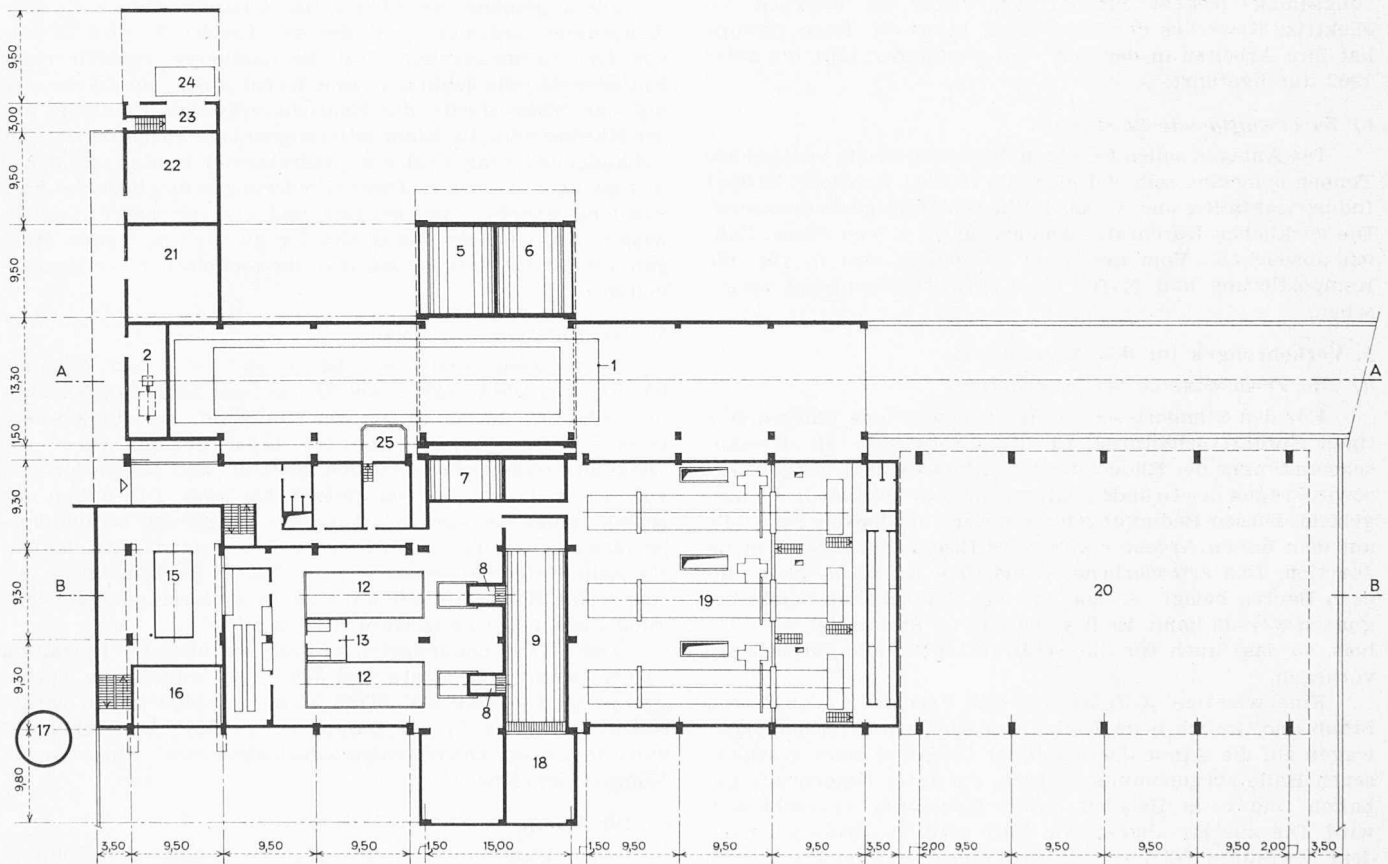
Grundriss der Werkanlagen Cheneviers, 1:800
